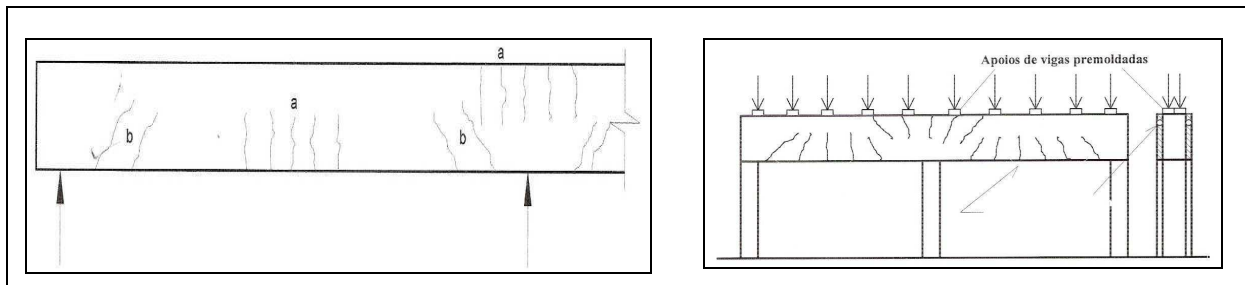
(a, b) - Fissuração por tração e compressão axial
